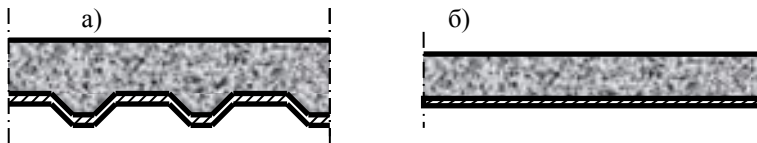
Поперечні перерізи сталезалізобетонних плит:
